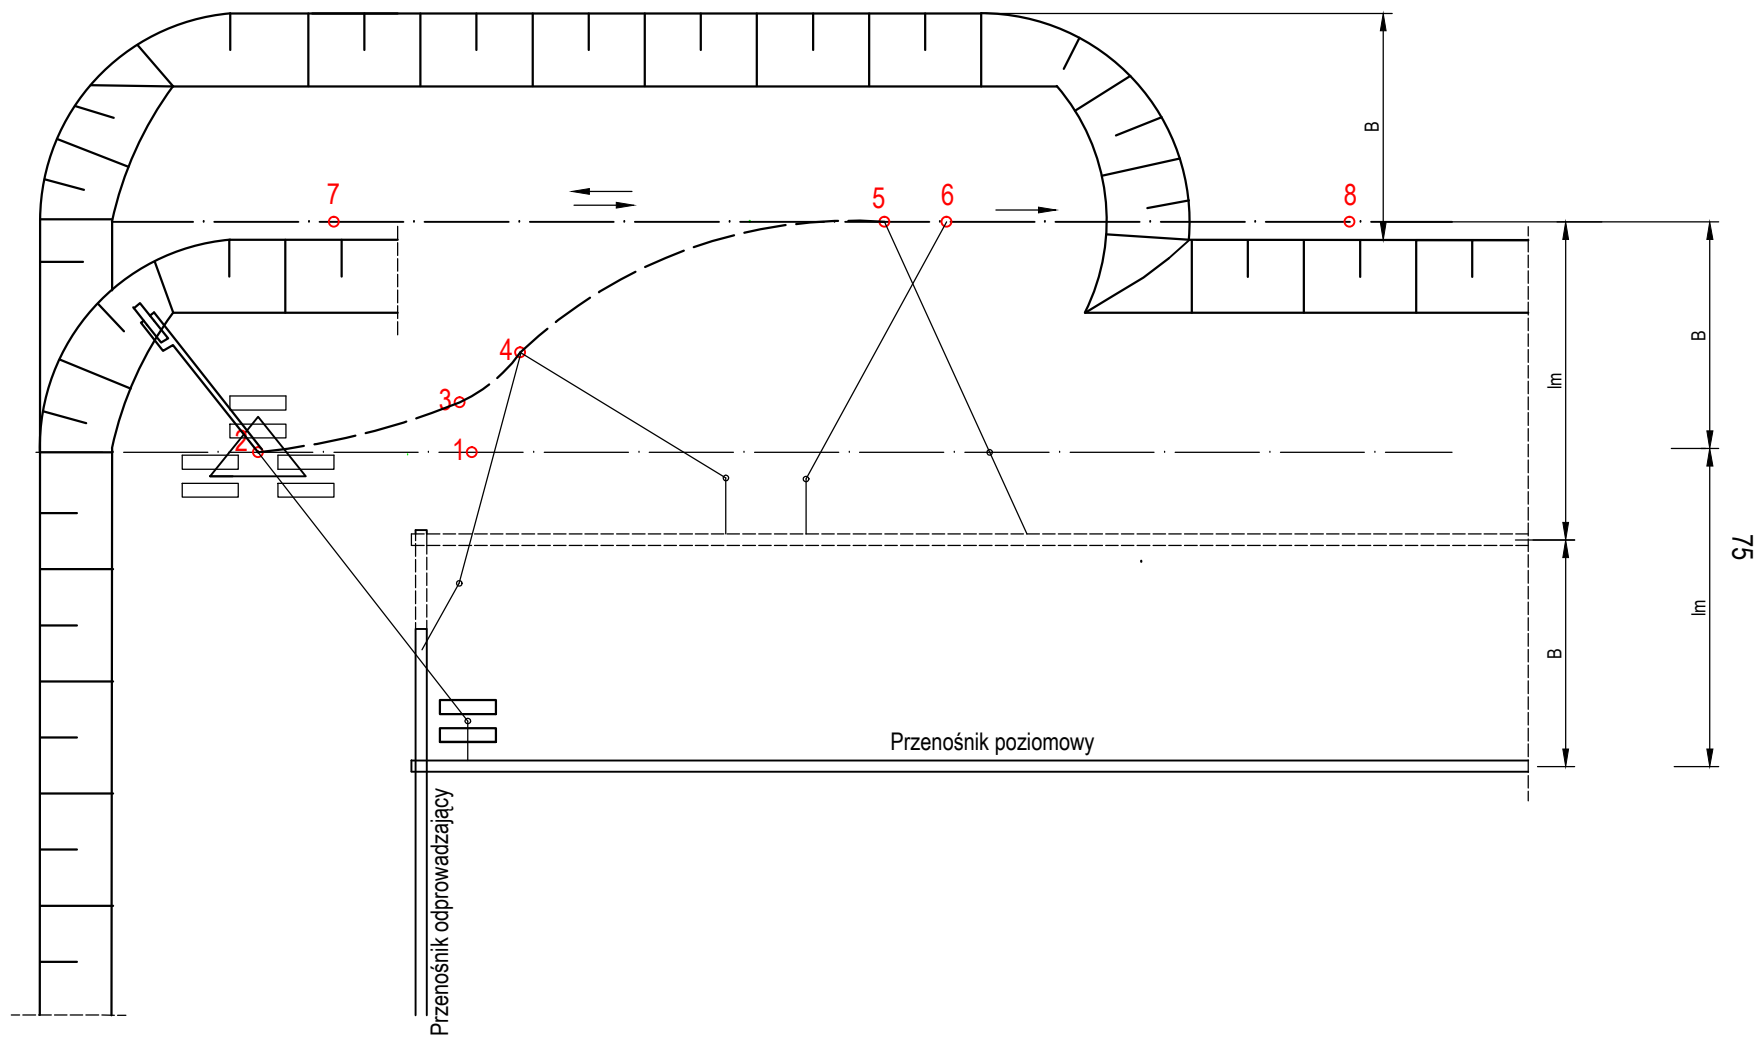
Układ podstawowych ruchów roboczych koła czerpakowego
